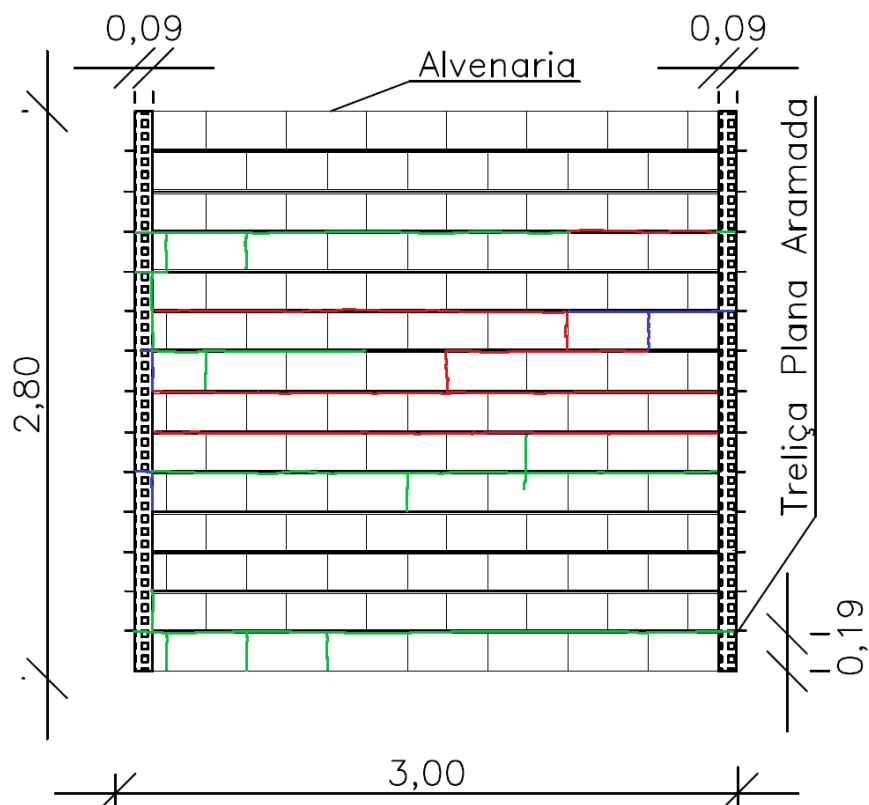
Mapeamento de fissuras da primeira alvenaria ALV – 6 (Vista frontal)
